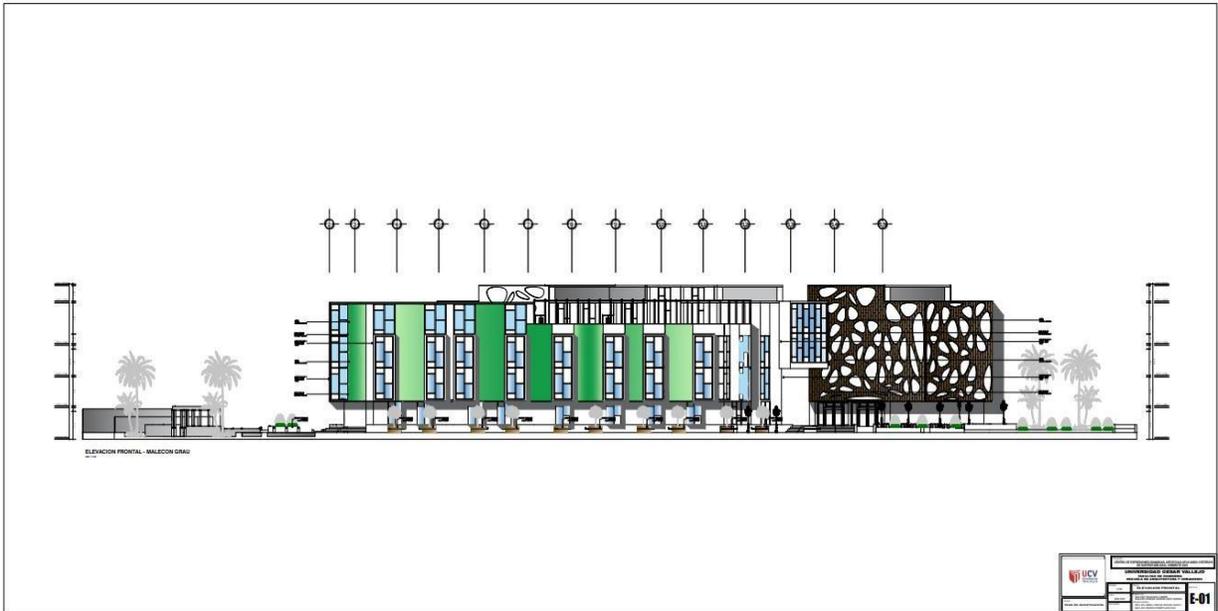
Plano Elevación Frontal. Fuente: Elaboración Propia
